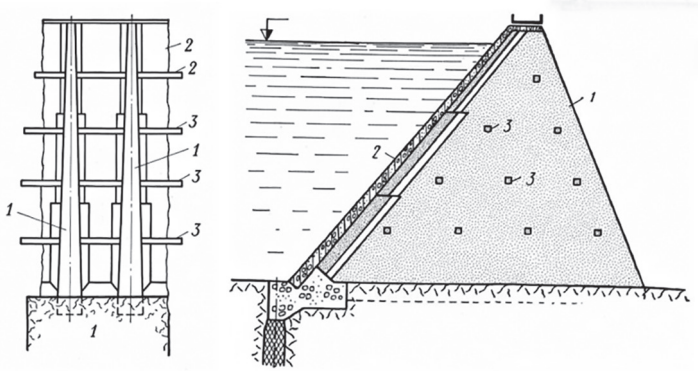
Ejemplo de la solución constructiva de una presa de contrafuertes con cubierta (pantalla) plana.
